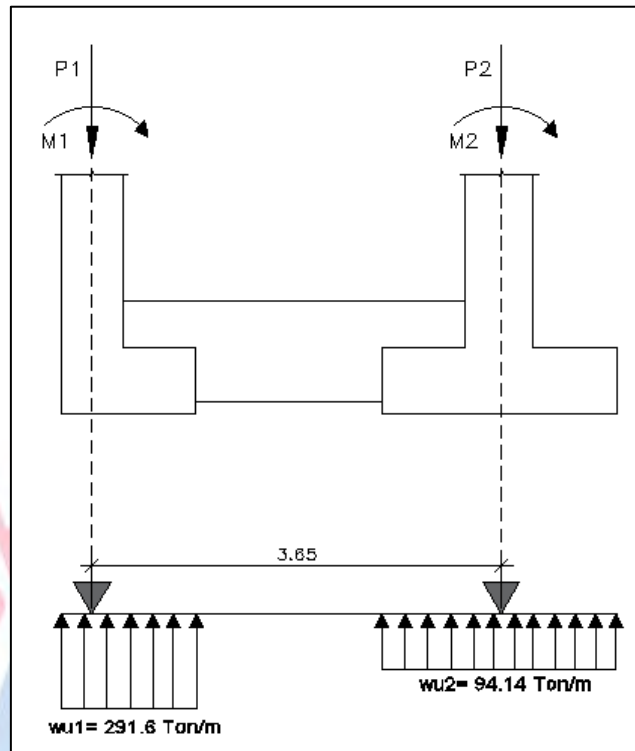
Modelo de viga simplemente apoyada en los elementos verticales.
